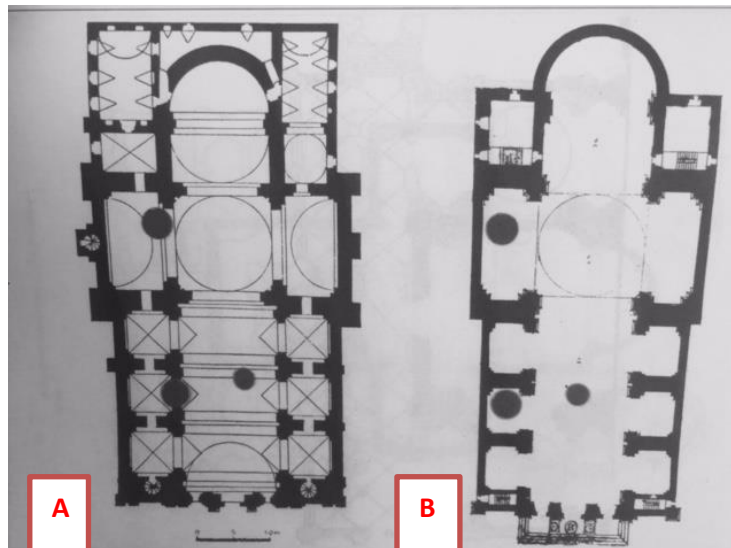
Grundriss der SS. Peter und Paul Kirche, A: der heutige Grundriss, B: Grundriss aus dem Jahr 1596, unter der Berücksichtigung der Kanalisationsgruben.
